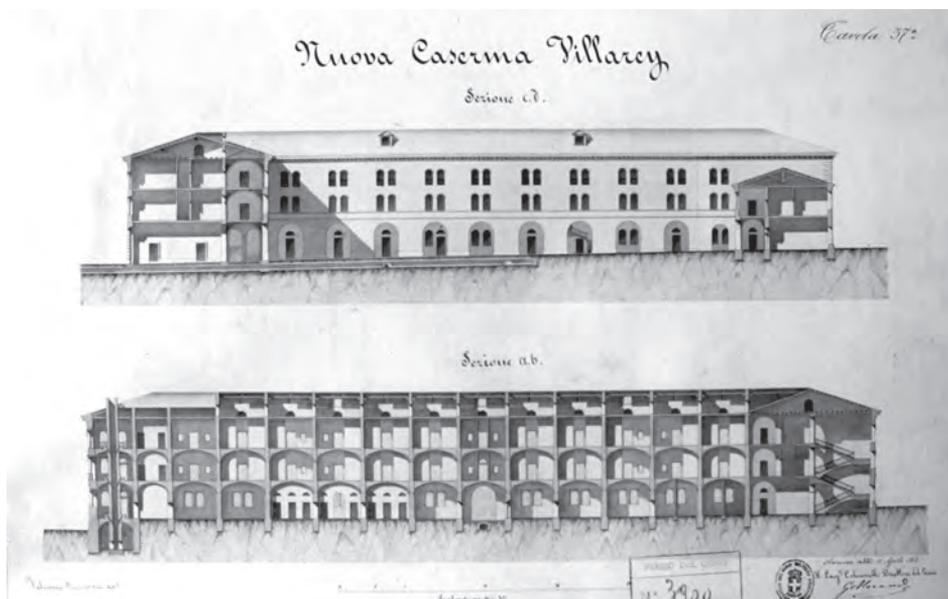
Valeriano Bernardini. 1868. «Nuova Caserma Villarey. Tavola 37ª. Sezione CD; Sezione AB. Scala 1:200». Archivio Storico dell'Istituto di Cultura dell'Arma del Genio di Roma (ISCAG).
